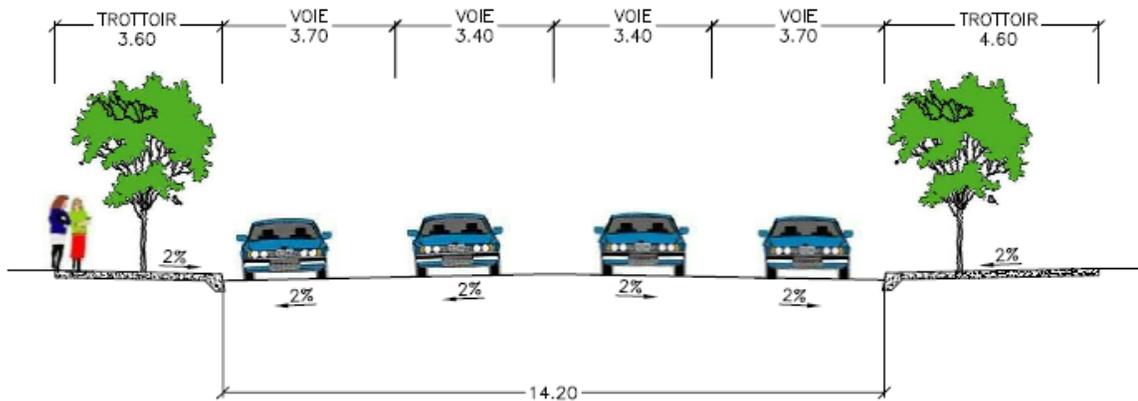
COUPE A-A DROIT - AUTOROUTE BONAVENTURE
